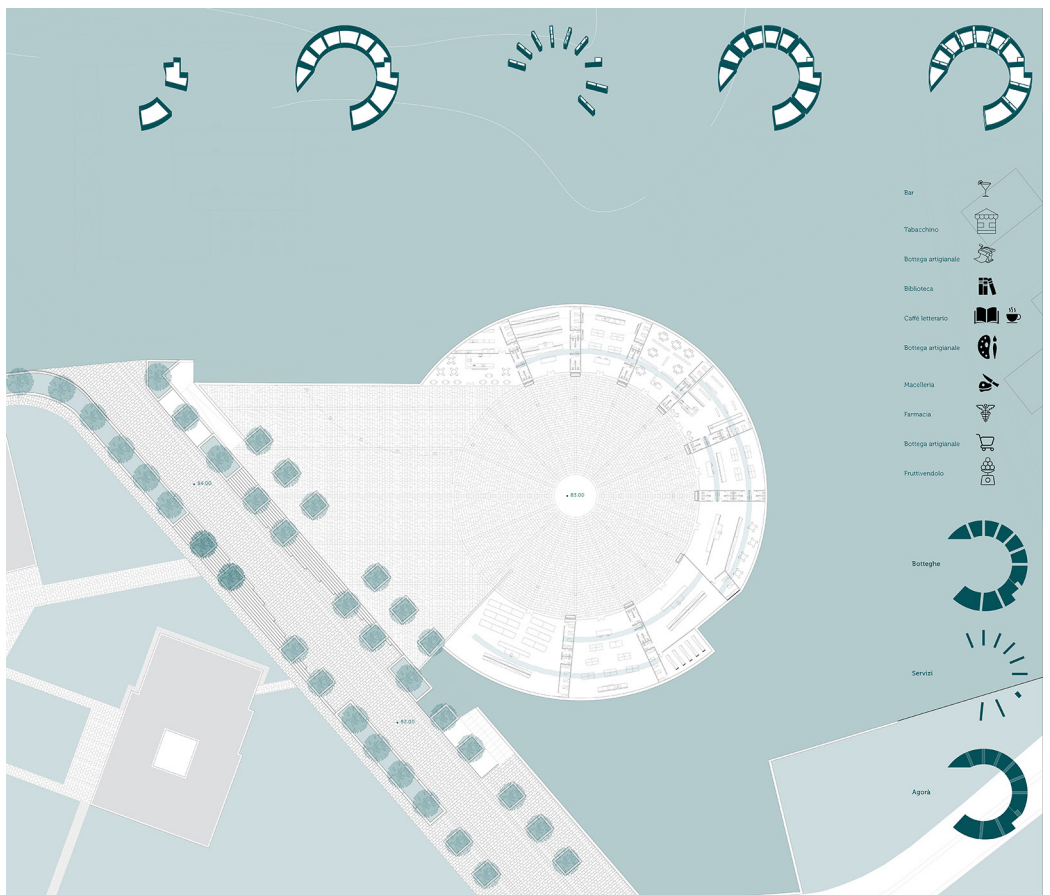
Progetto della piazza e delle botteghe dell'Agorà di Peschiera. Pianta piano terra. Elaborazione grafica di Alessandra Dichio.
